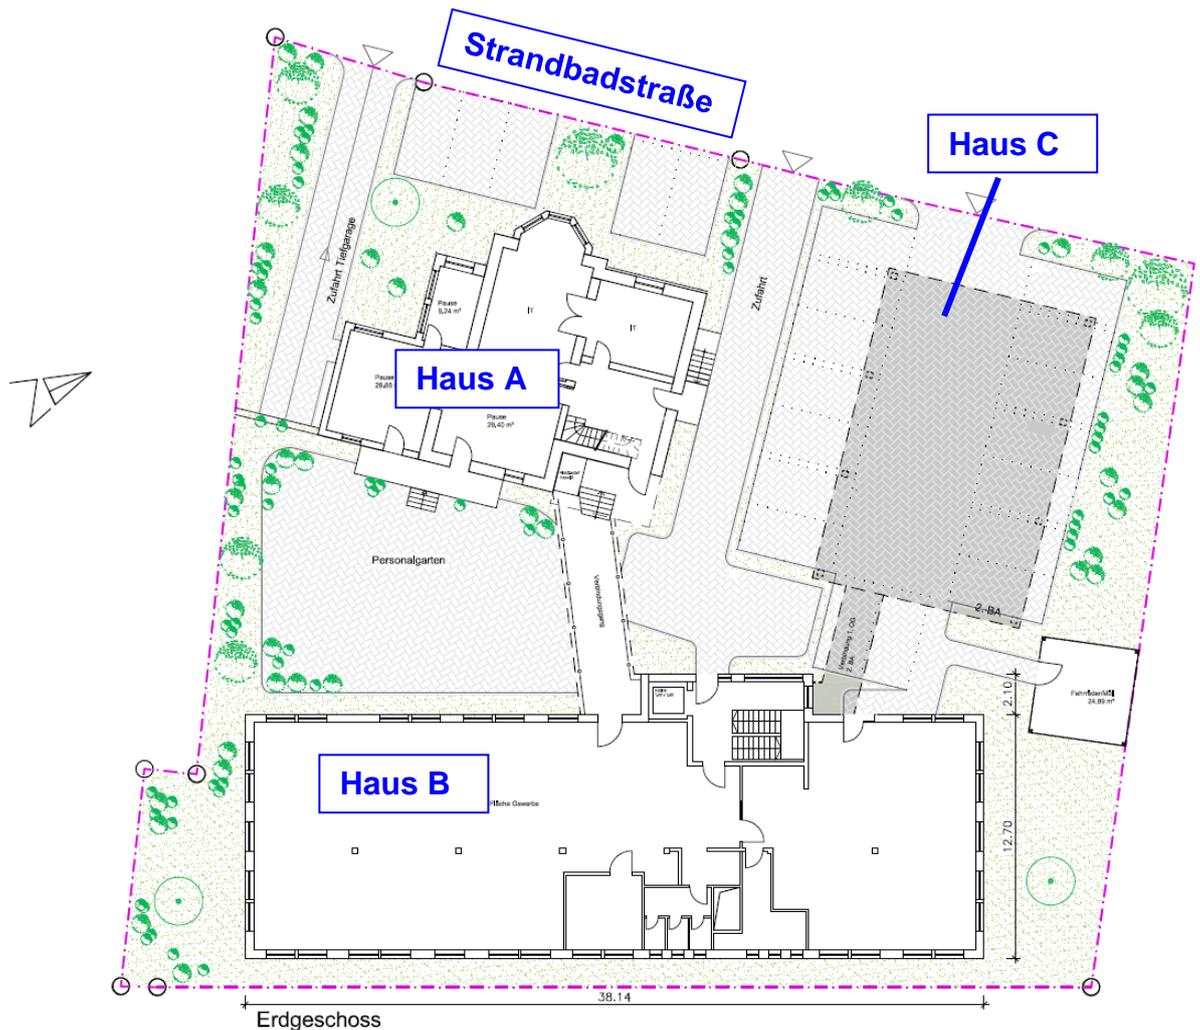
Lageplan Erdgeschoss, o.M., Stand 09./2016, Architekturbüro Winter
